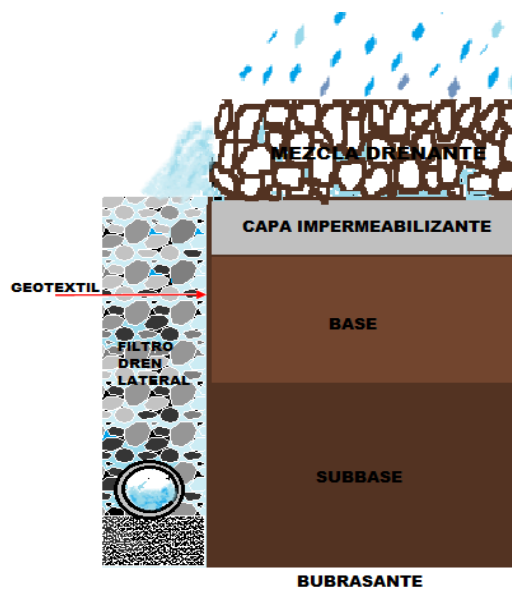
Ejemplo de drenaje lateral del tipo cajón para pavimentos con capa superficial drenante
